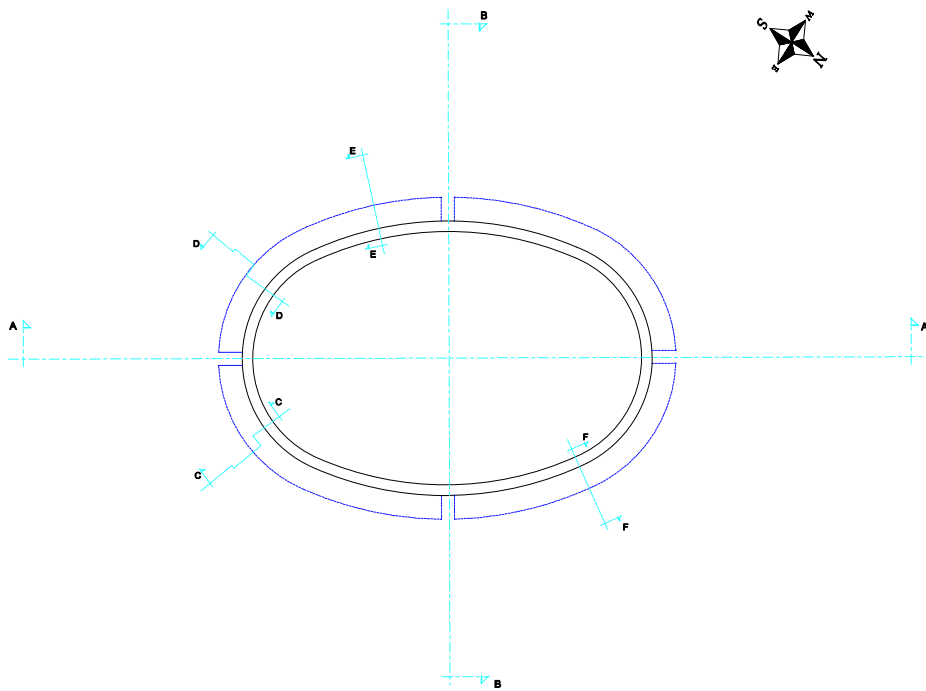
教会堂の平面図 (第 2 コーニスレベル)
